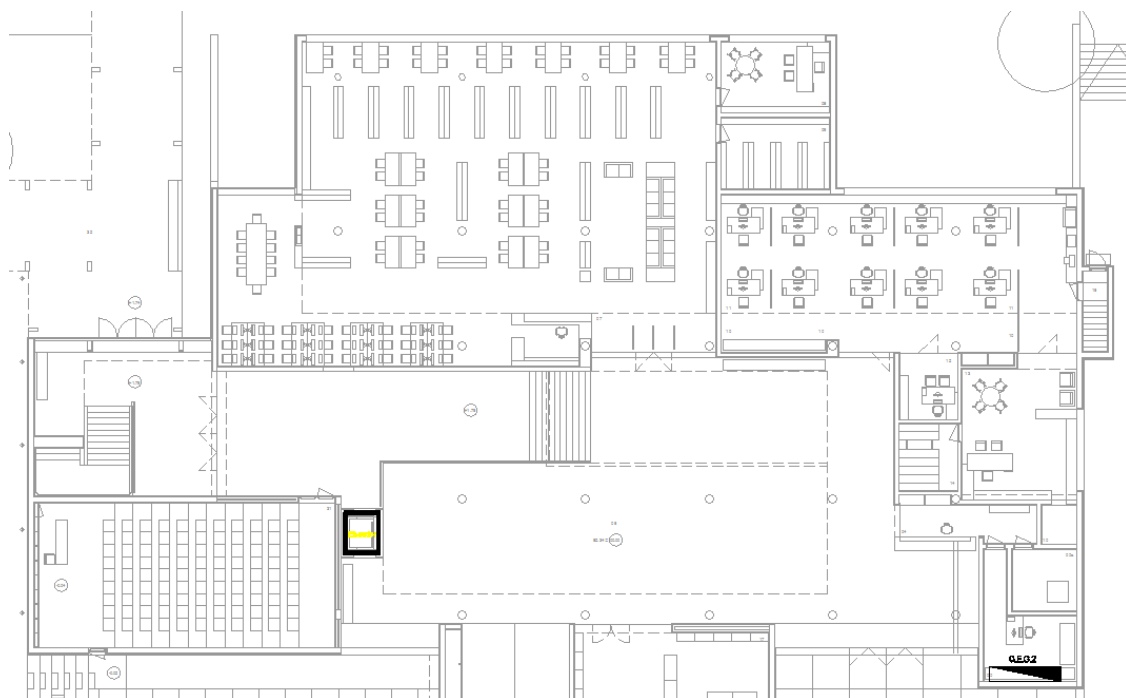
Único elevador existente na escola, situado no corpo 2.
